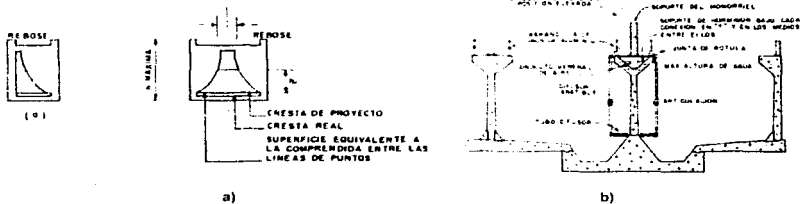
Desarenadores a) Sección de un desarenador de flujo horizontal; b) sección transversal de un desarenador aireado
